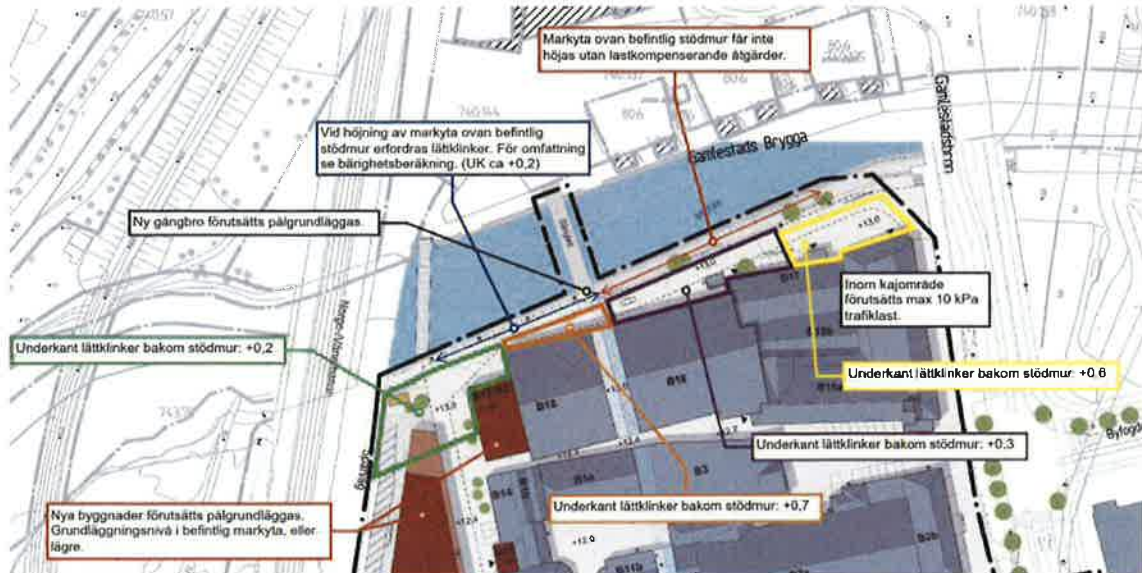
Förslag till stabilitetshöjande åtgärd genom utfyllnad med lättklinker. För fullständiga beräkningar se till planen hörande geotekniska PM (Sweco 2011-10-28, rev. 2018-09-04)
